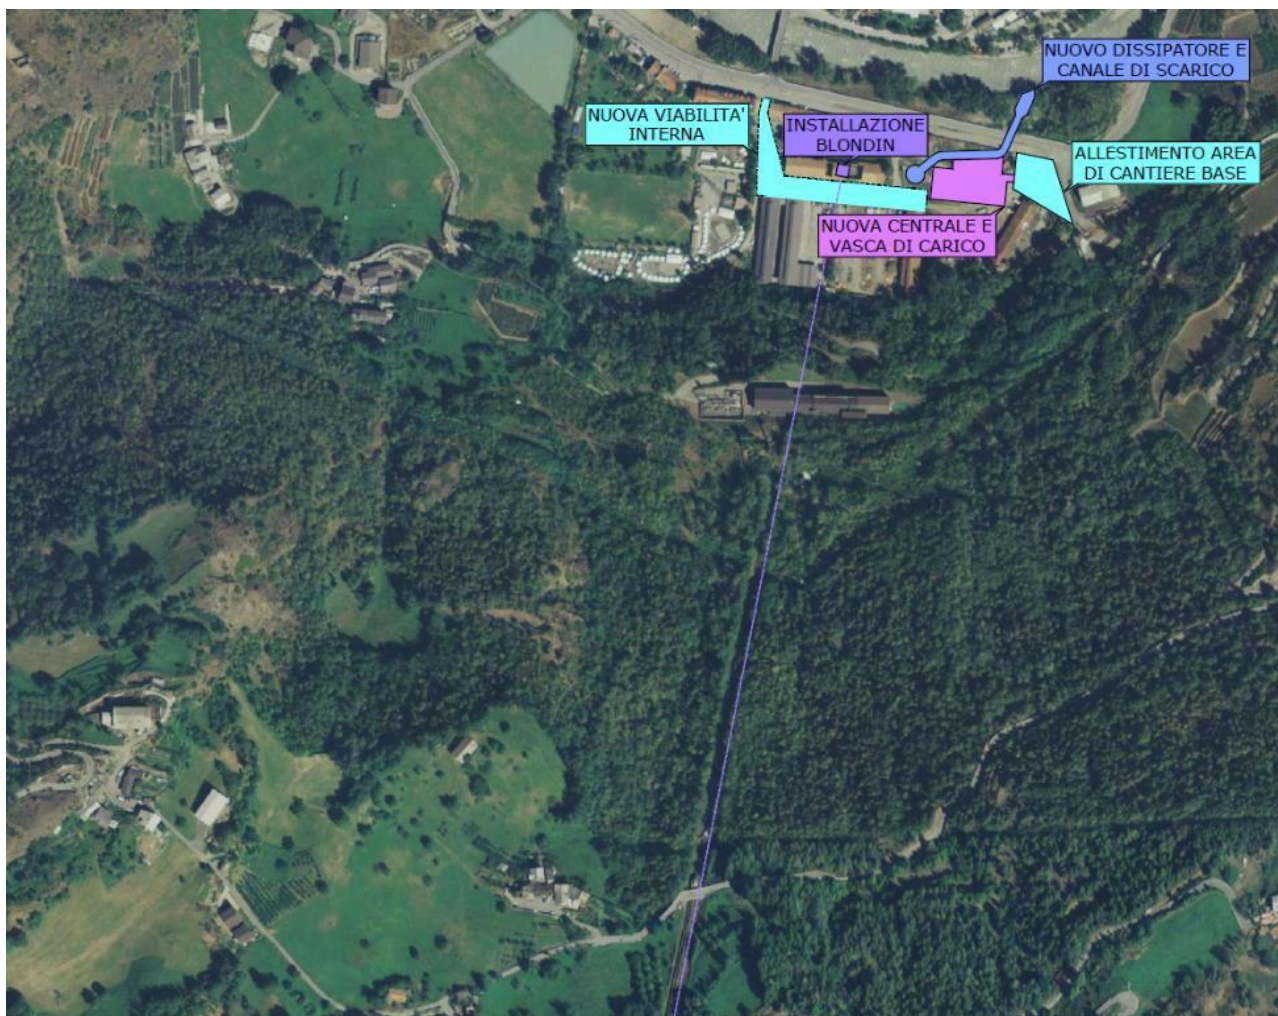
Lotto III cantiere E fase I realizzazione fabbricato centrale e opere idrauliche di restituzione
